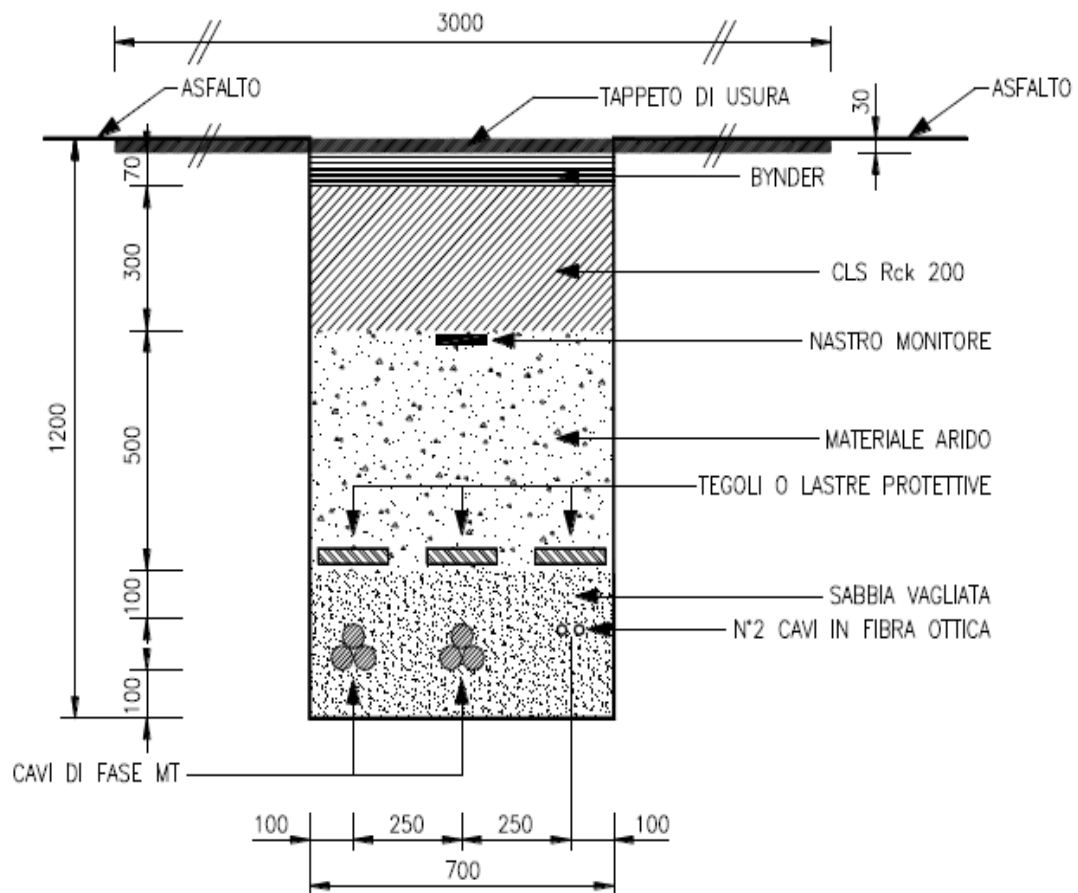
Sezione tipica di posa della linea in cavo su sede stradale
